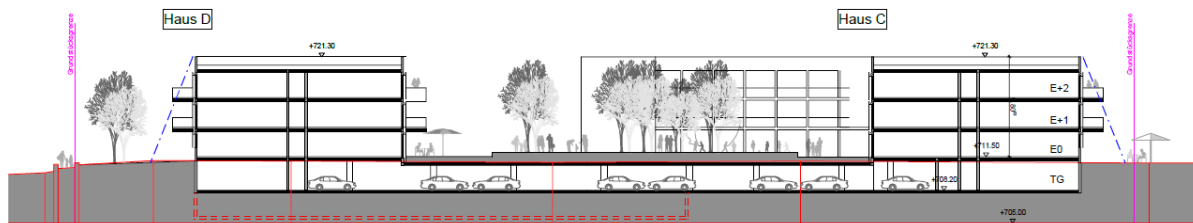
Plankonzept mit Tiefgarage, Querschnitt.
